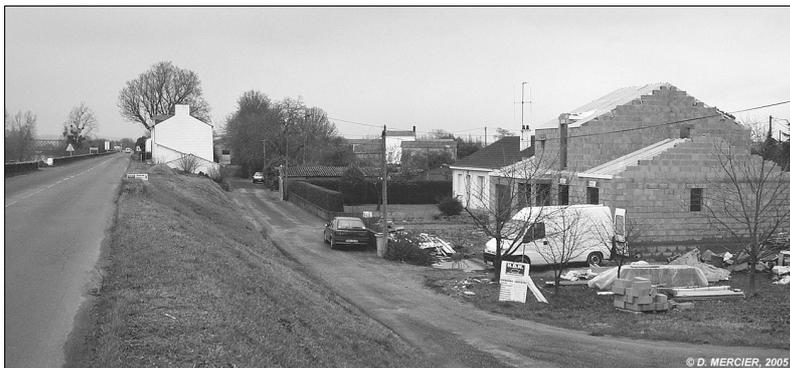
Construction dans les "dents creuses" (La Chapelle-Basse-Mer)
